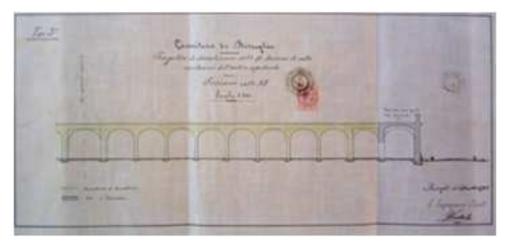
Progetto di demolizione delle 12 sezioni di celle mortuarie dell'antico sepolcreto, sezione (1902)
